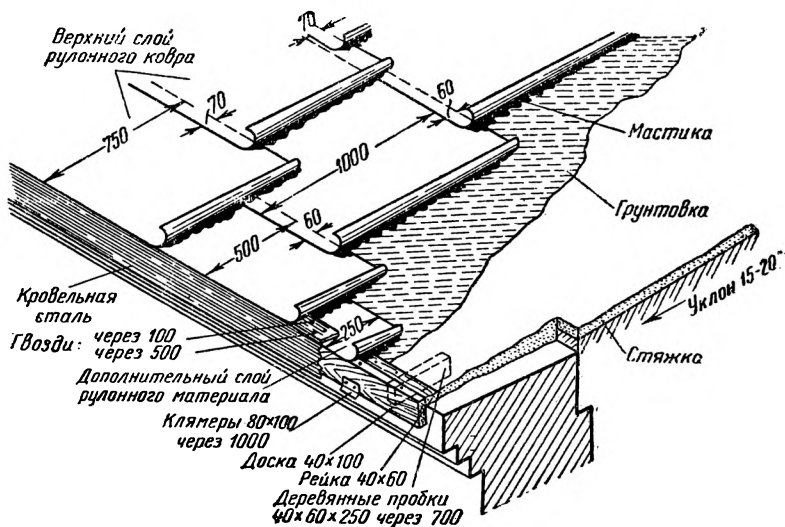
Двухслойный рулонный ковер на уклонах кровли от 15 до 20%
